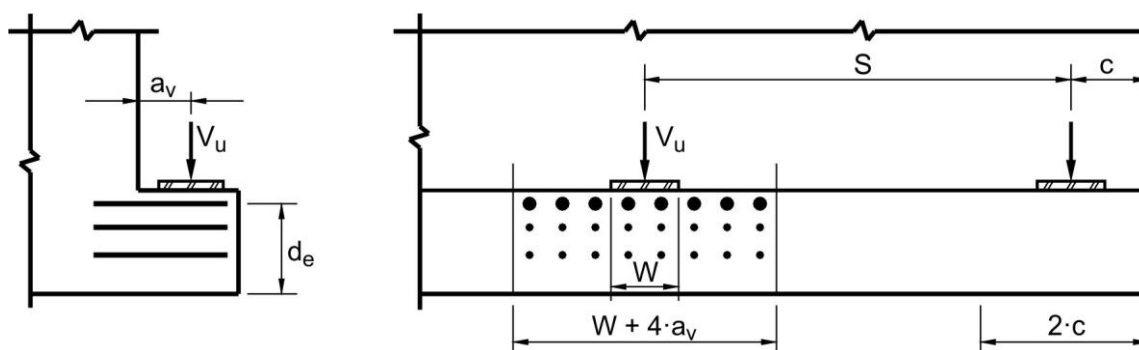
Diseño al corte de la viga con resaltos horizontales
